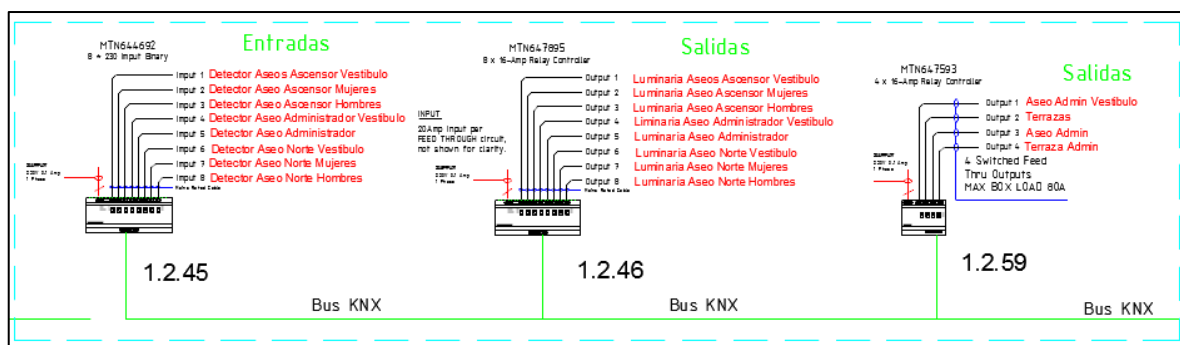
Elementos KNX de cuadro de Planta Primera
